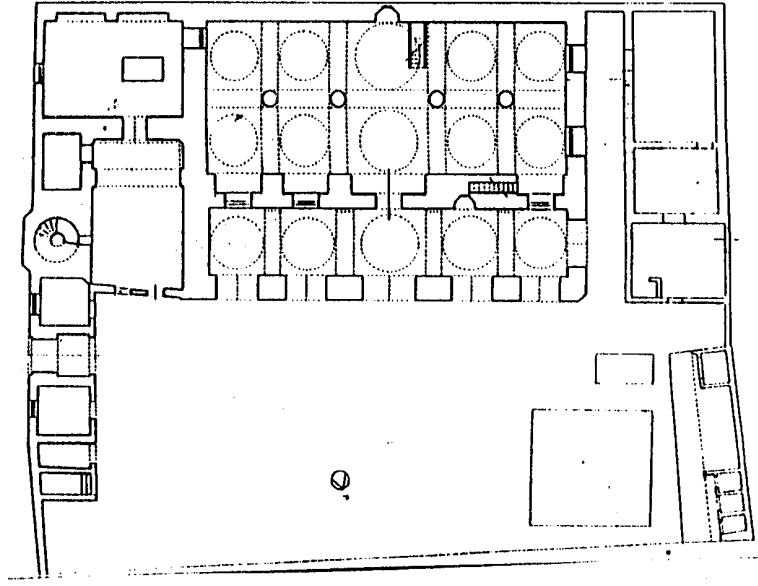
مسقط أفقي لمسجد الدباغ بطرابلس الغرب
